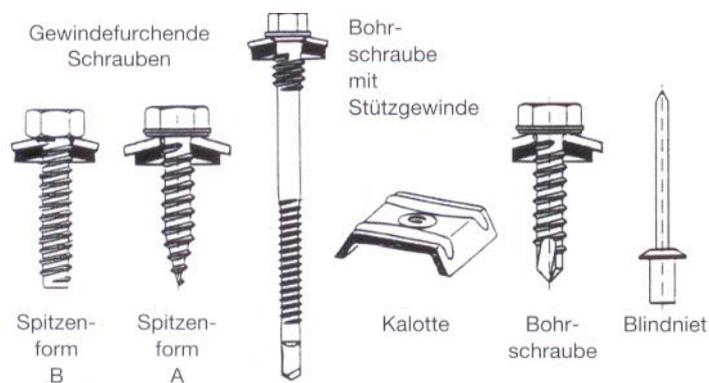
Bauaufsichtlich zugelassene Verbindungselemente für den Stahlleichtbau
